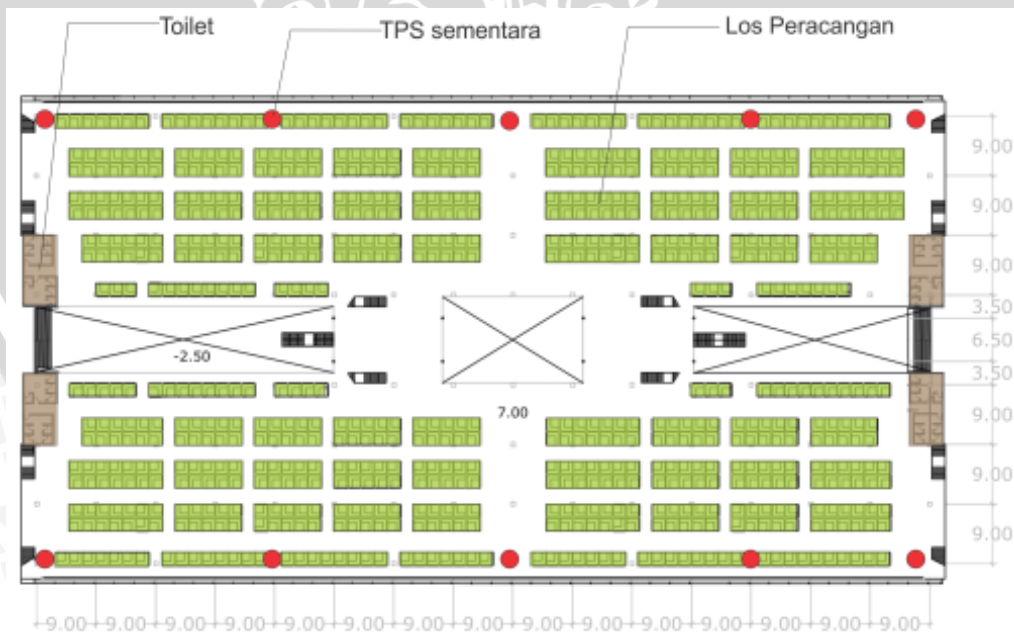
Zoning Komoditas dagang pada lantai 2 (FIG I)
